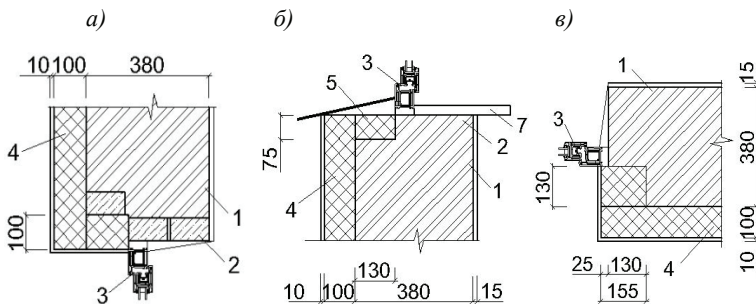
Способ устройства дополнительного утепления в углублениях наружной стены оконного проема: а – верх, б – низ, в – боковая грань. 1 – наружная стена, 2 – железобетонная перемычка, 3 – оконное заполнение, 4 – наружная теплоизоляция, 5 – дополнительный слой утеплителя, 6 – слив, 7 – подоконник.
